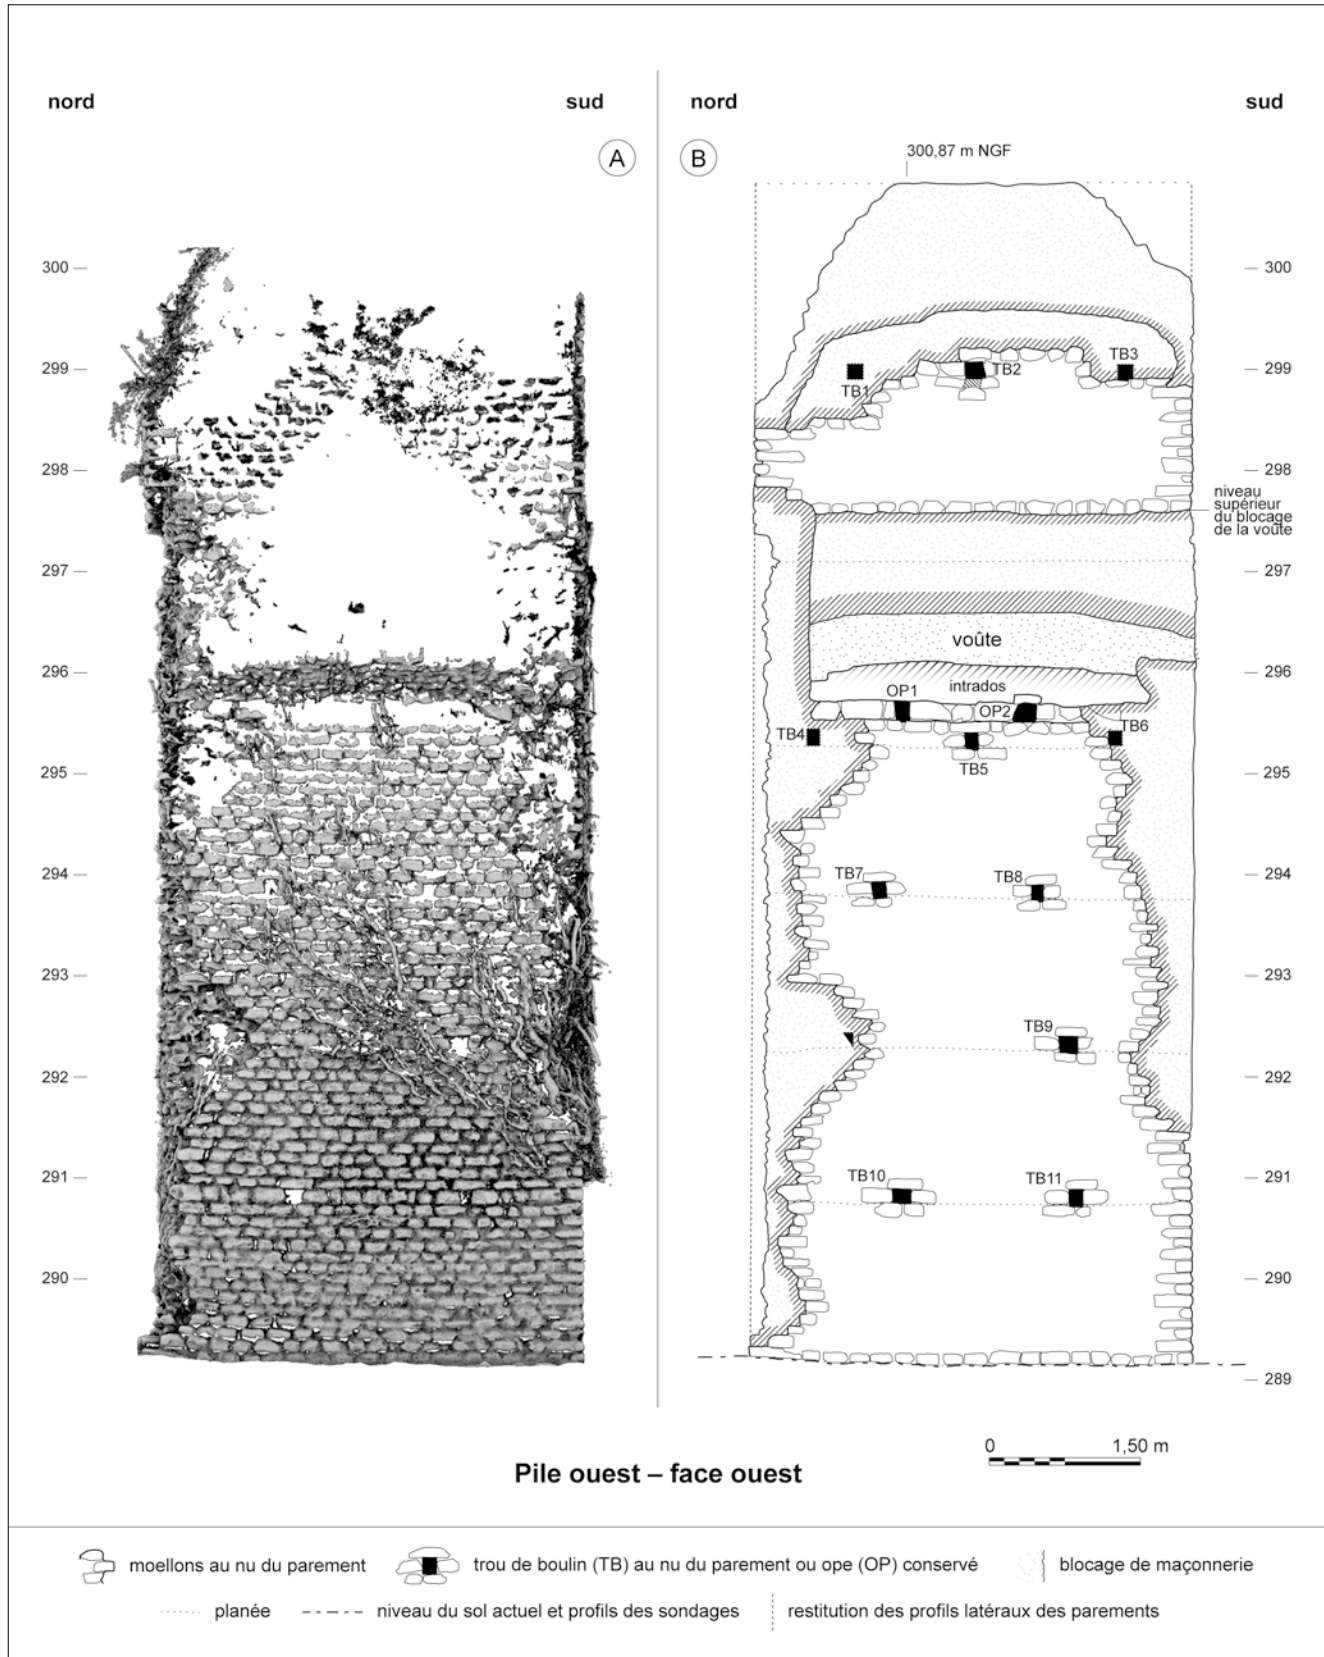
La pile ouest du double rampant des Tourillons à Craponne: A, ortho-image de la face ouest; B, relevé d'élevation de la face ouest (ortho-image: O. Veissière; DAO: D. Baldassari).
